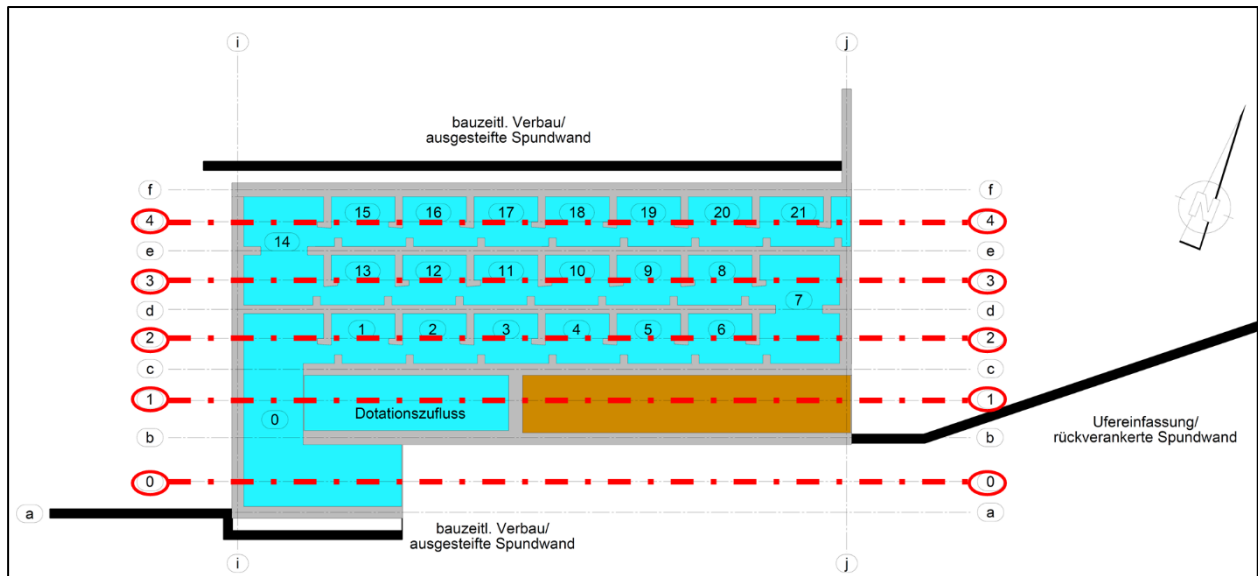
Grundriss Einstiegsbauwerk – Achseneinteilung
